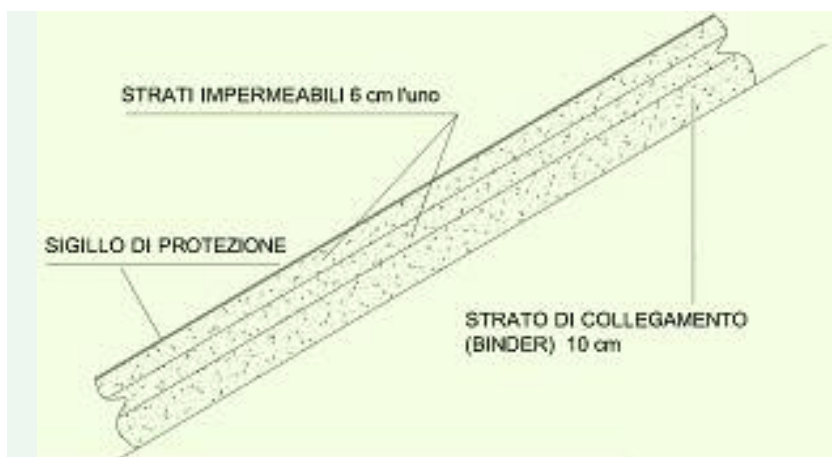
Sezione della sovrastruttura impermeabilizzante della diga di Chabrouh
